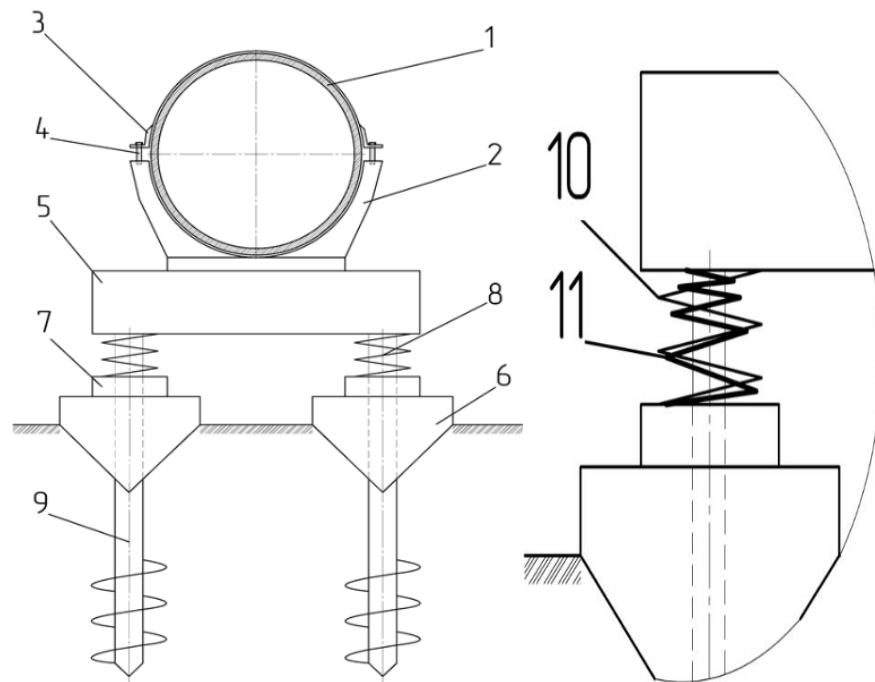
Схема конструкции опоры надземного магистрального трубопровода, где: 1 – трубопровод; 2 – ложемент; 3 – полухомут; 4 – болтовое соединение; 5 – стол-ростверк; 6 – опорная плита; 7 – шайба; 8 – демпфер; 9 – винтовая свая; 10 – внешняя пружина; 11 – внутренняя пружина [73]
